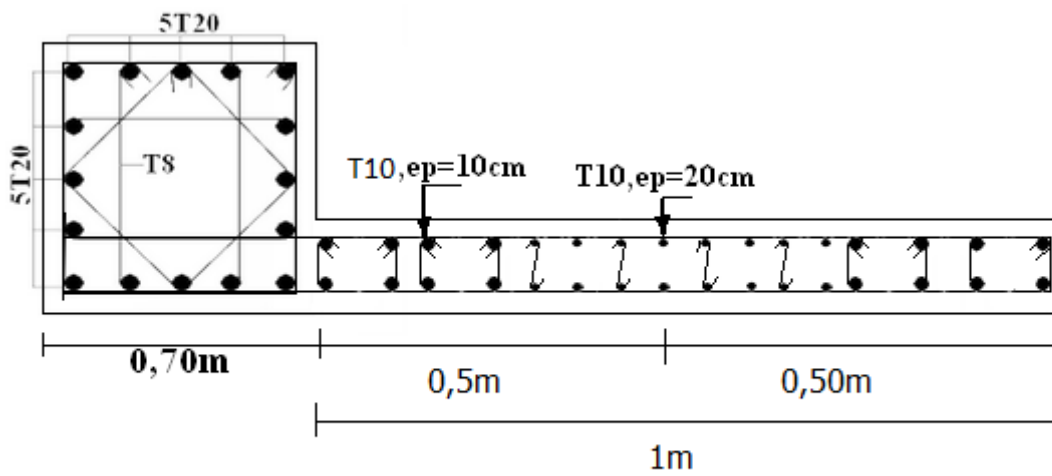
Schéma ferrailage des voiles (V5 et V6) coupe horizontaux.
